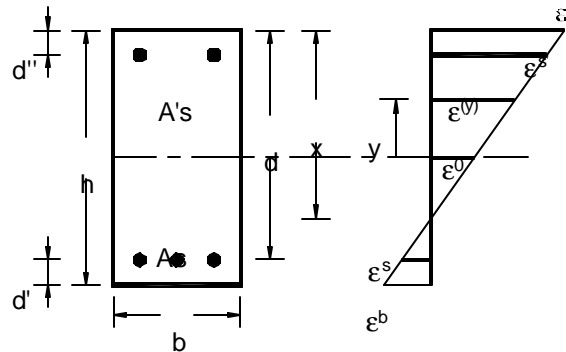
(a) Seção em concreto armado; (b) Distribuição das deformações na seção transversal.
